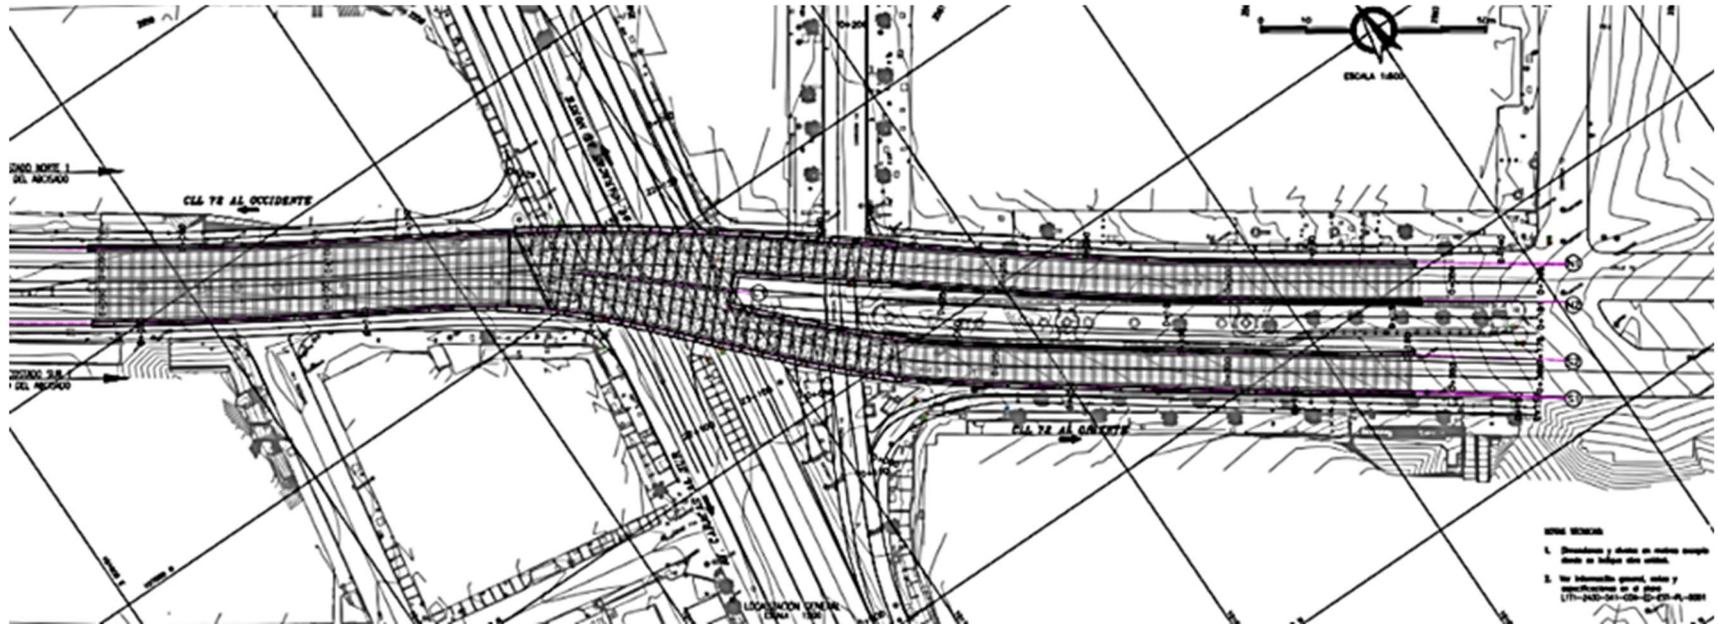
Planta deprimido Av. Calle 72 con Av. Caracas
